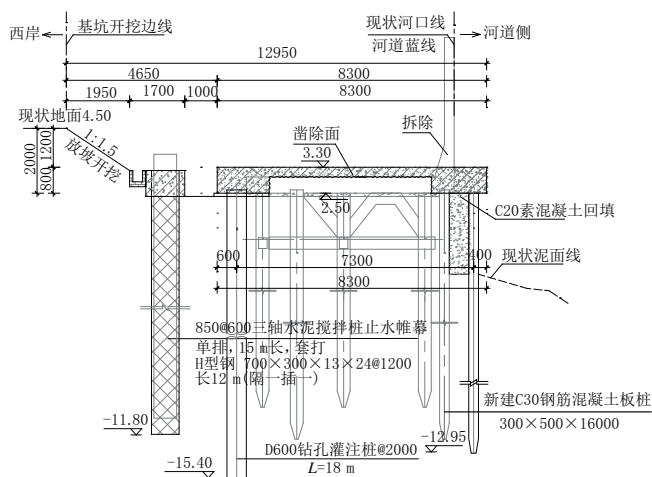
基坑围护断面图[单位:mm(尺寸);m(高程)]
